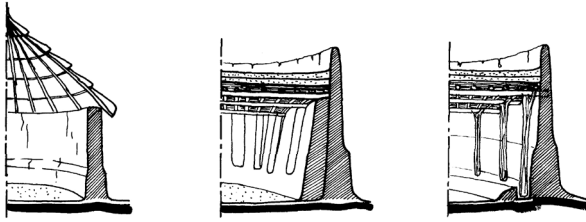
Distintos tipos de sistemas estructurales y cubiertas
